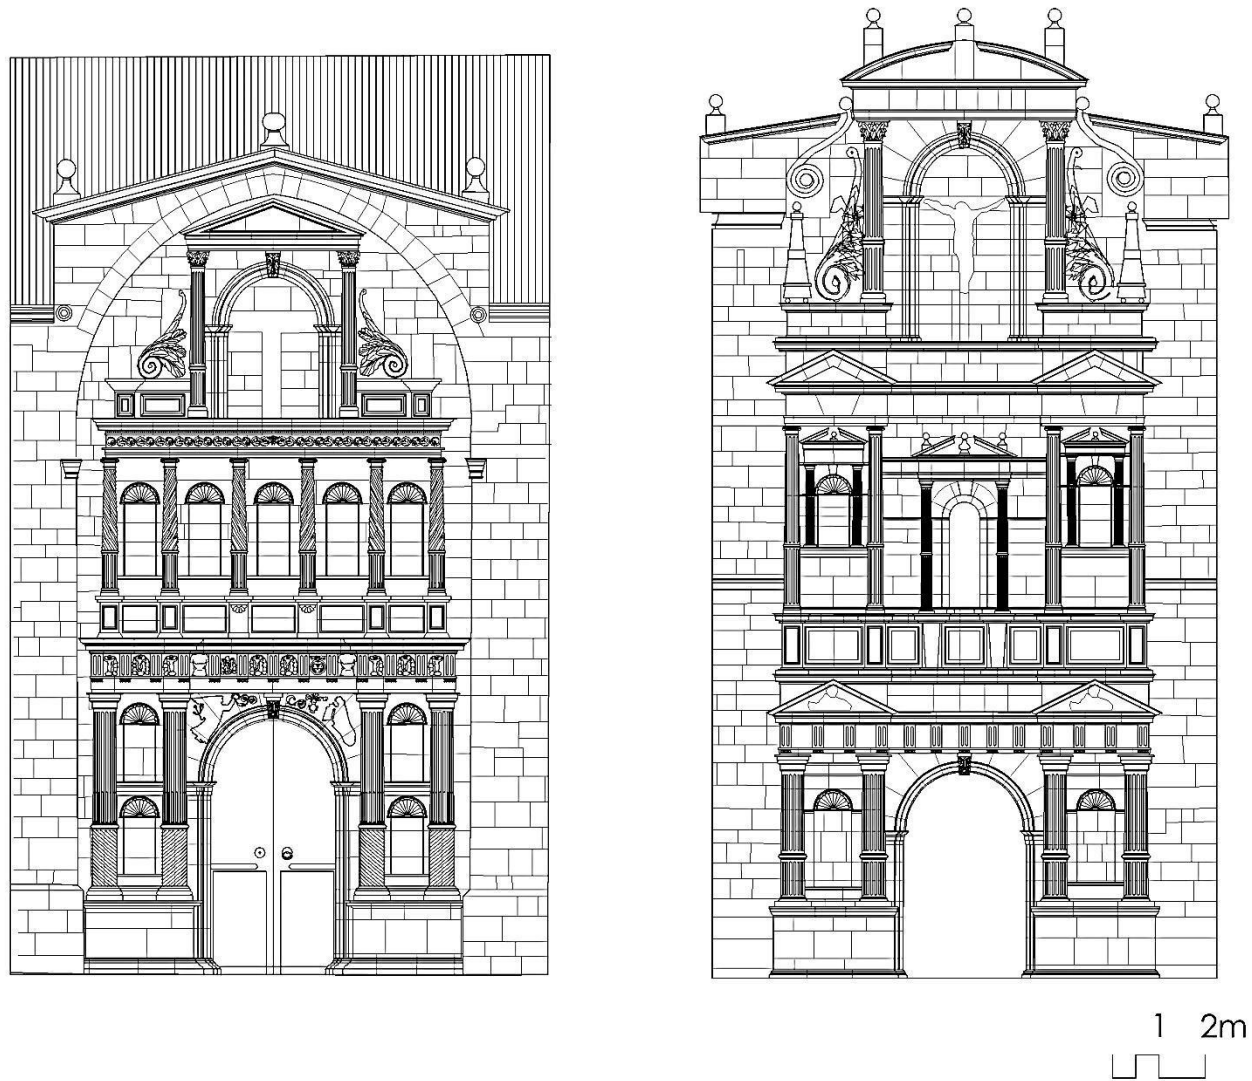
Despiece de las sillerías de las fachadas retablo de Vistabella (Castellón) y Andorra (Teruel).
